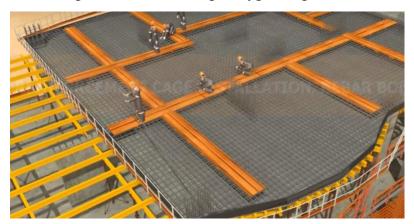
Организация рабочего места арматурных работ <u>Бетонные работы</u>
